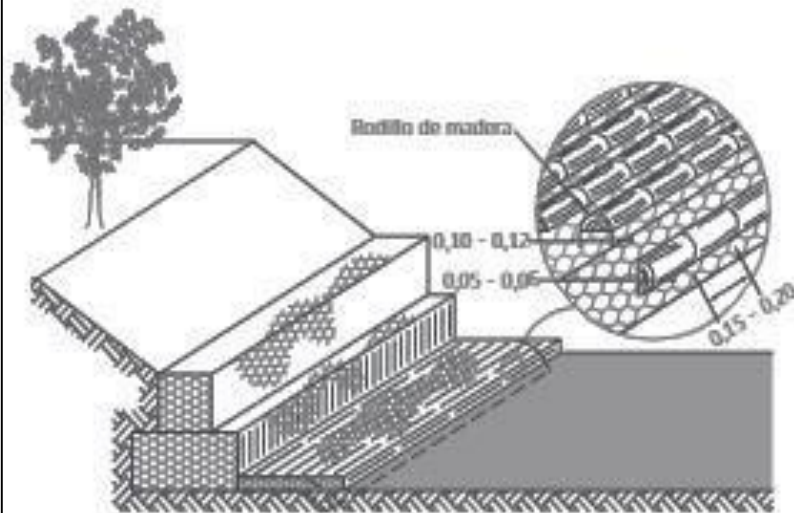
Sección transversal de muro en gaviones protegidos con radillos de madera
